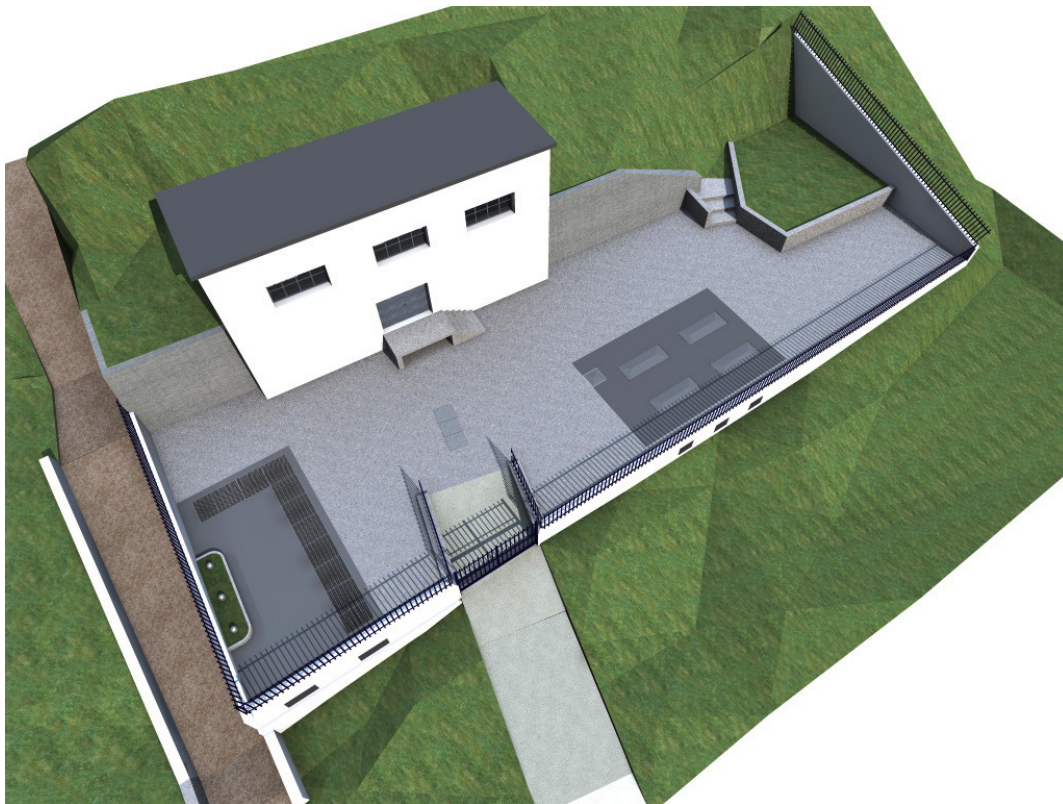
Vista generale dell'impianto in località San Salvatore in seguito alla realizzazione degli interventi in progetto
